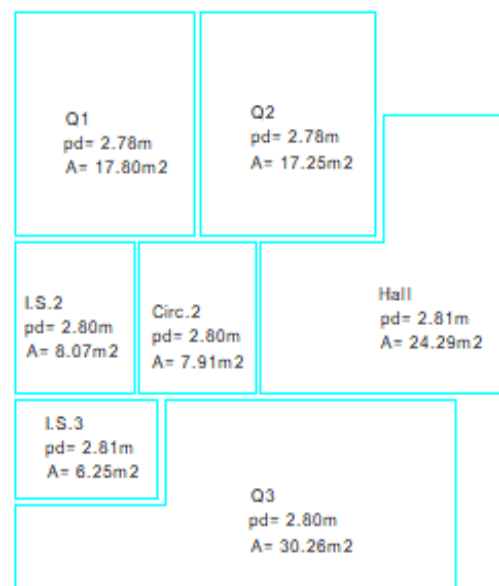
Planta da fracção com a delimitação das envolventes e planta de áreas (caso 3 - sem escala).
